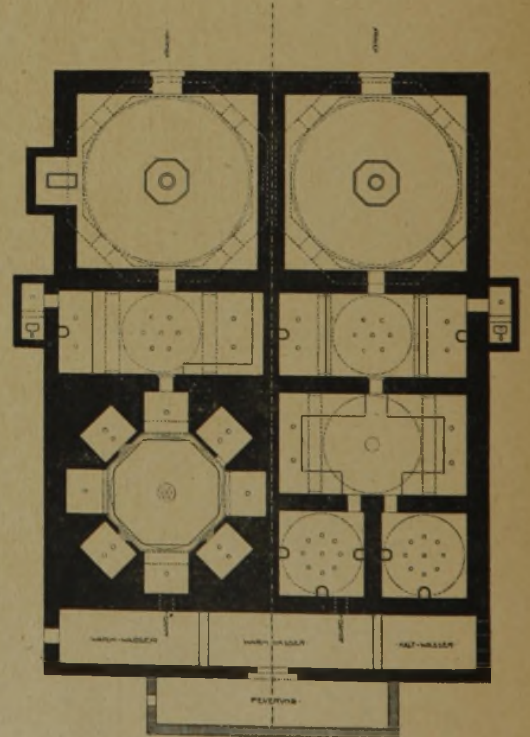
Jenischehir Hamam. Grundriß 1:400.
